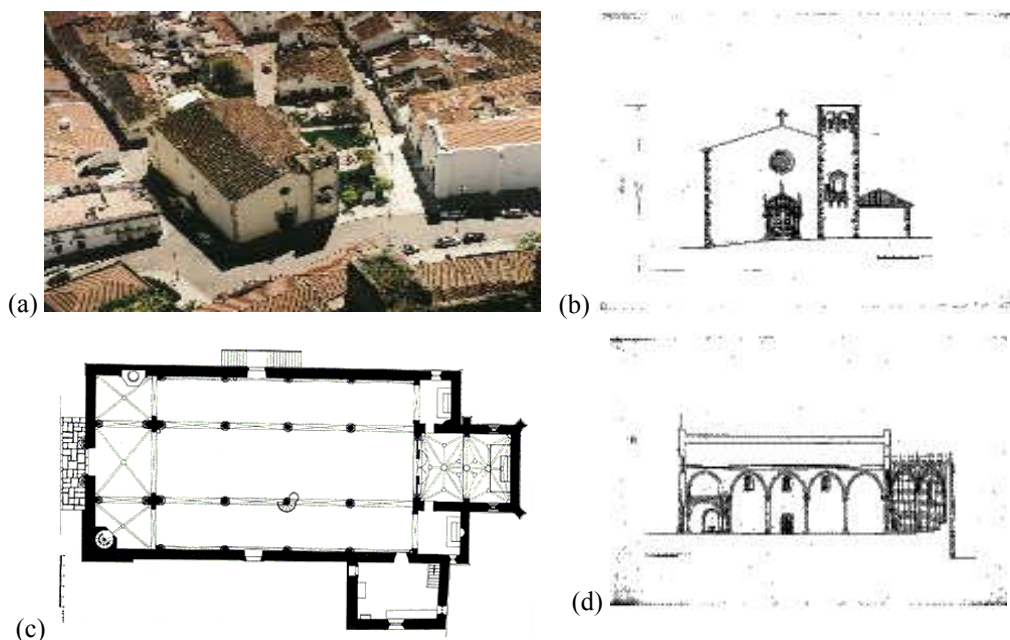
Peças desenhadas [Fonte: DGEMN]: (a) fotografia; (b) alçado da fachada principal; (c) planta e (d) corte longitudinal.
